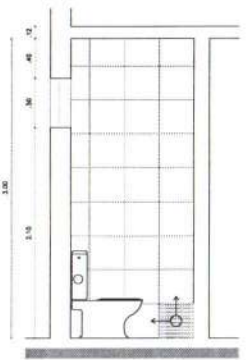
SANITÁRIA ESCALA 1/2
